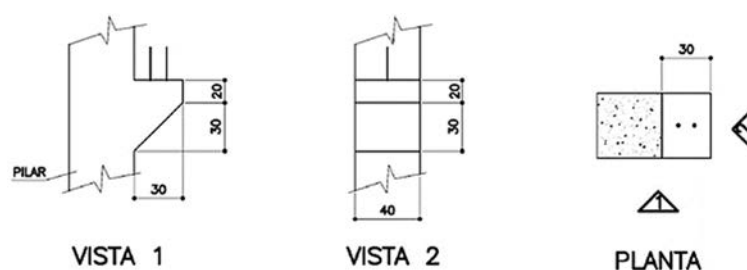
Formato dos consolos trapezoidais para as vigas de cobertura. Fonte: MELO (2007)
